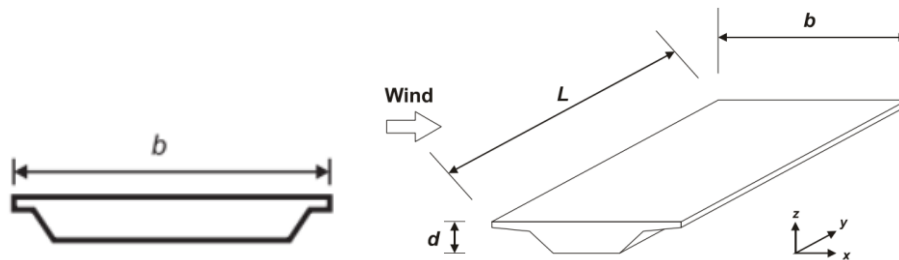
Secção transversal esquemática – tabuleiro de betão
